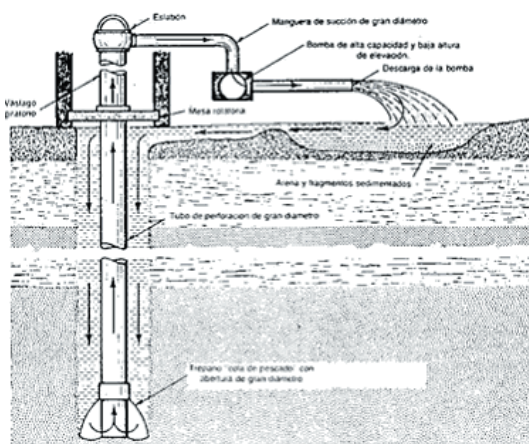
Esquema de un corte de terreno con pozo profundo.
